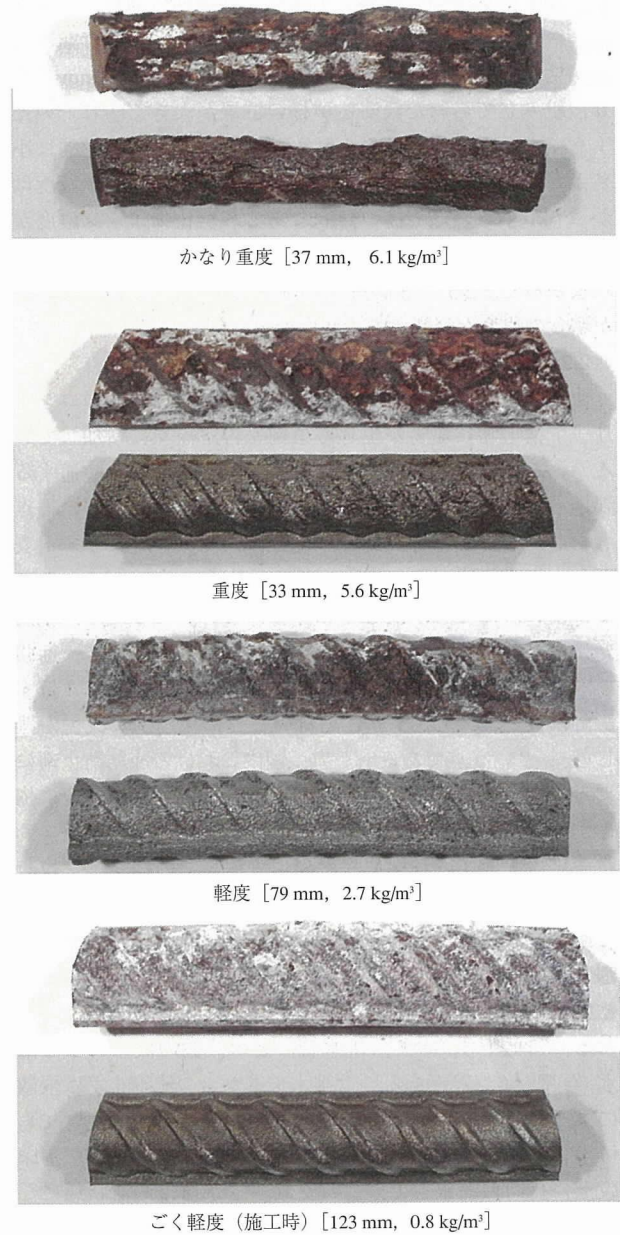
鉄筋の腐食程度 (いずれも配力筋, D16)
